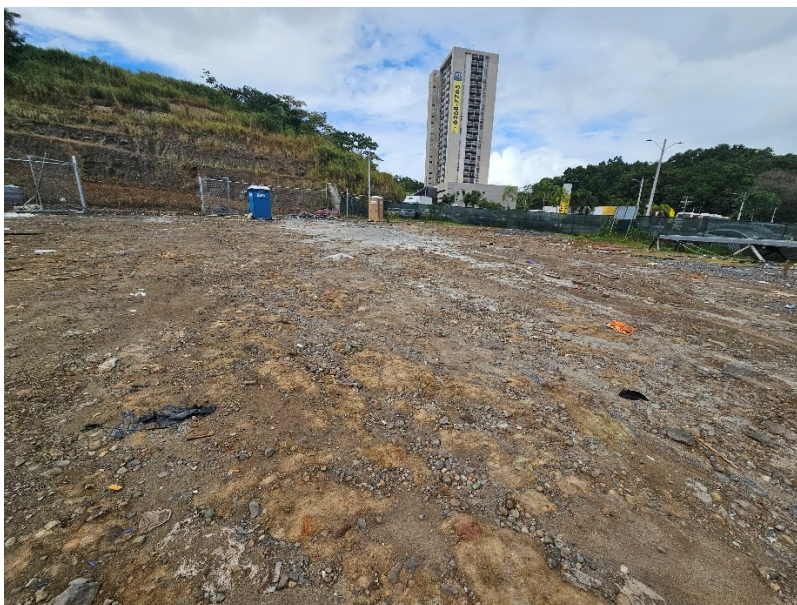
Foto del paisaje cercano al área del proyecto.
